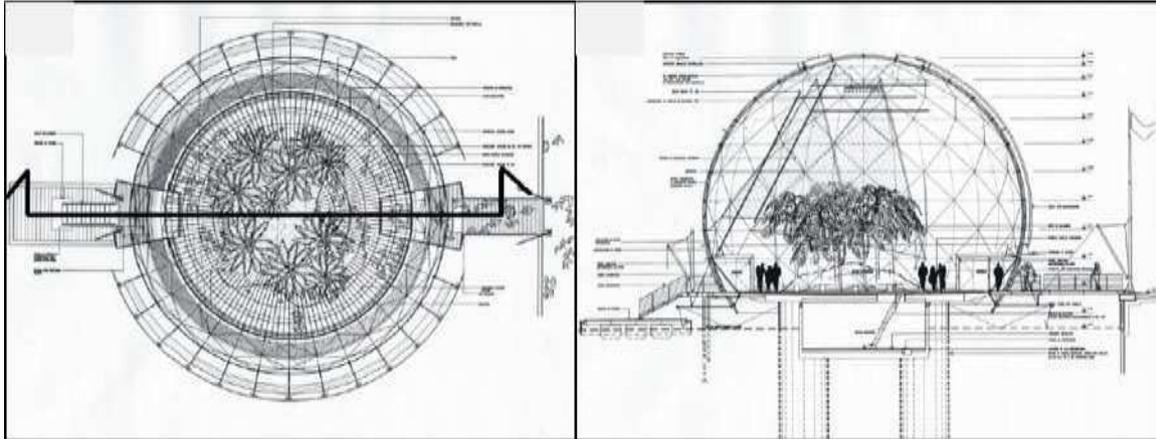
vue ne plan et une coupe du la biosphère “le bolla”.
